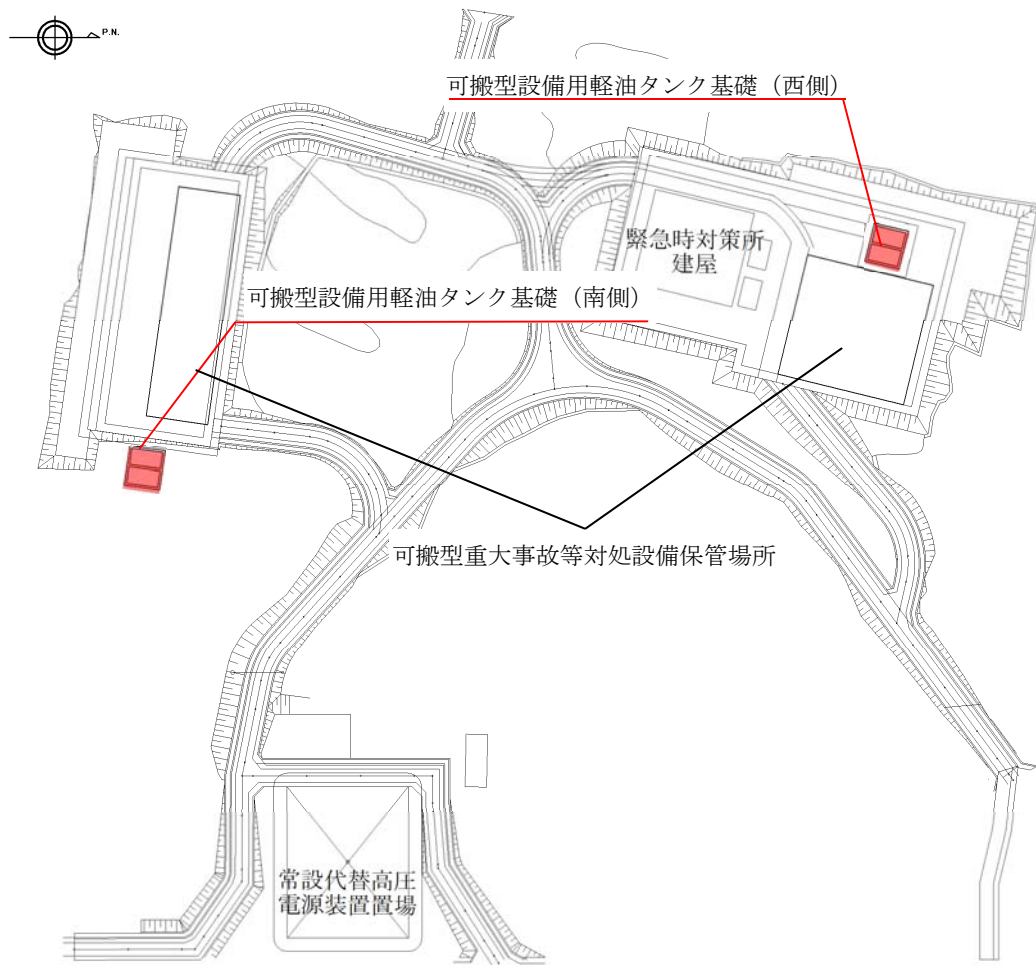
可搬型設備用軽油タンク基礎の位置図（全体平面図）
